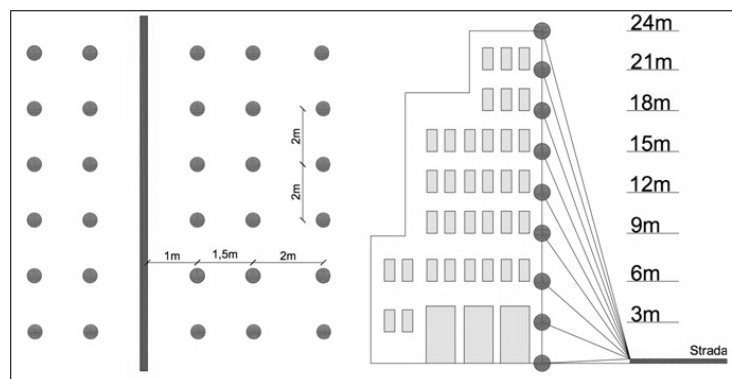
Distanza dalla fonte ai ricettori in pianta e in alzata
